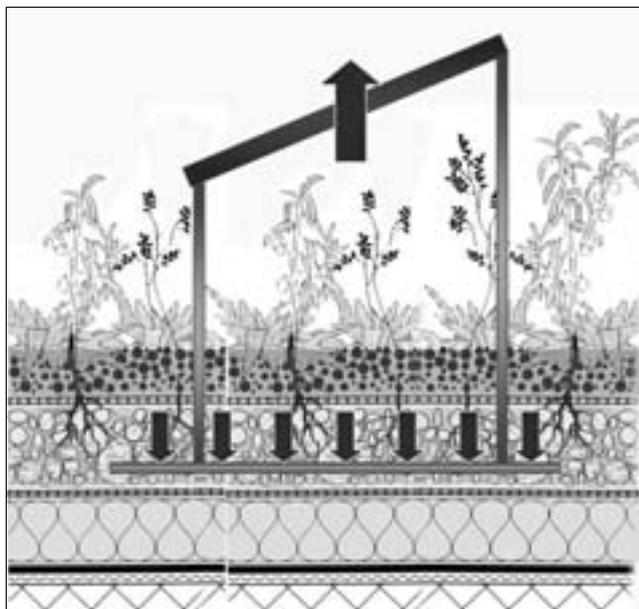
Schematische Darstellung des Dachaufbaues (von unten nach oben):
